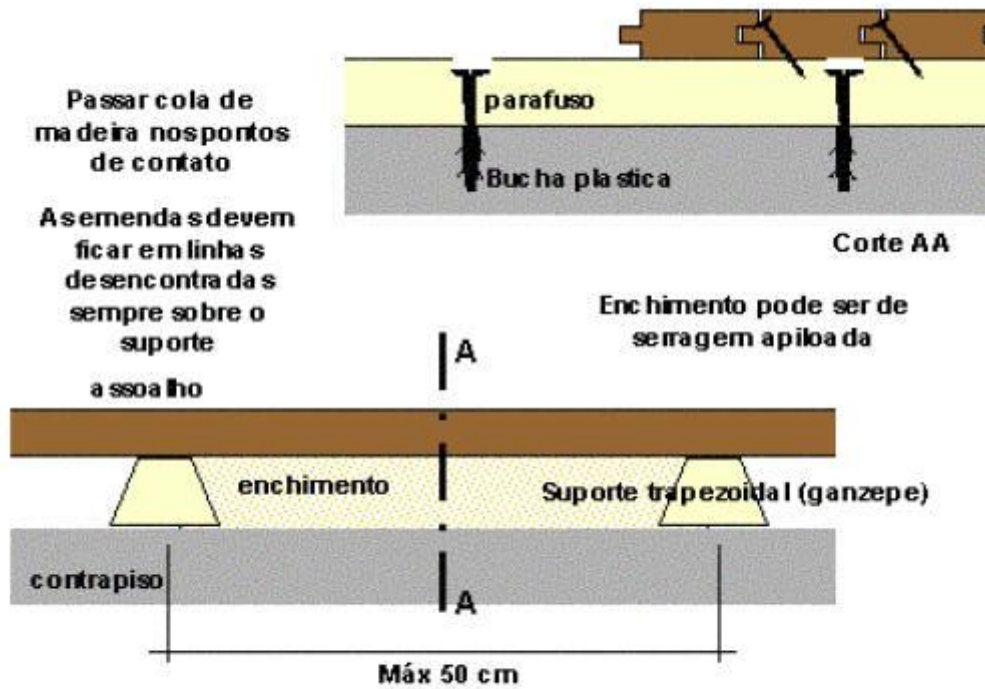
Assoalho sobre contrapiso de concreto com enchimento (acústica).
